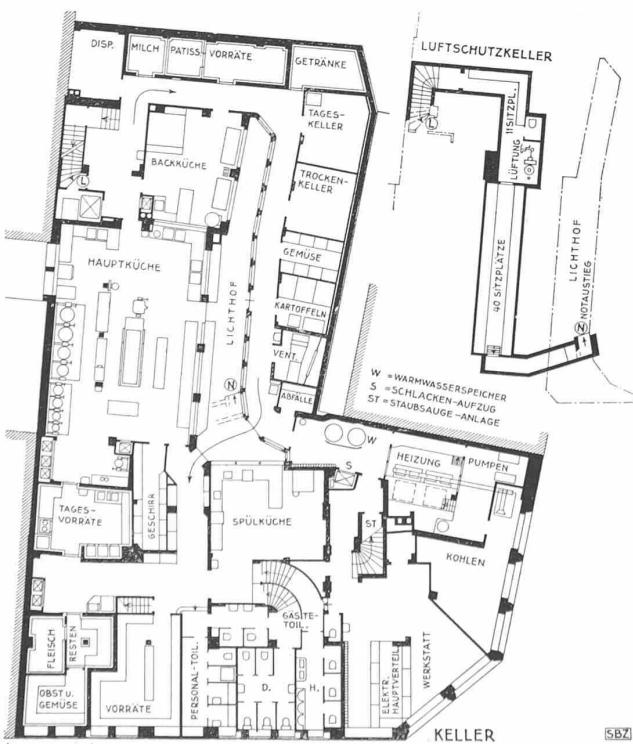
Grundriss Kellergeschoß, 1 : 400
